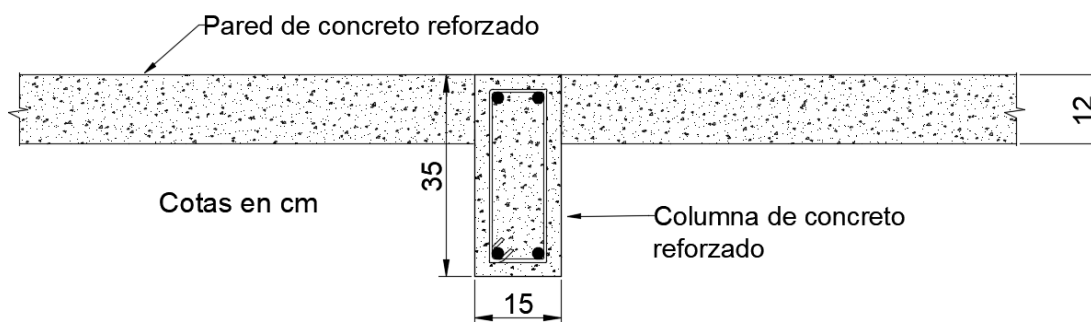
Vista en planta de la pared y columna de concreto reforzado
